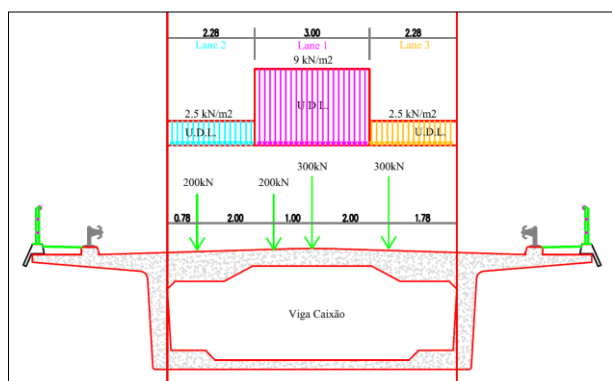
ESQUEMA DE DISTRIBUIÇÃO DO GRUPO GR1A PARA ANÁLISE TRANSVERSAL DA LAJE CENTRAL (GR1A-LAJE-MV)
